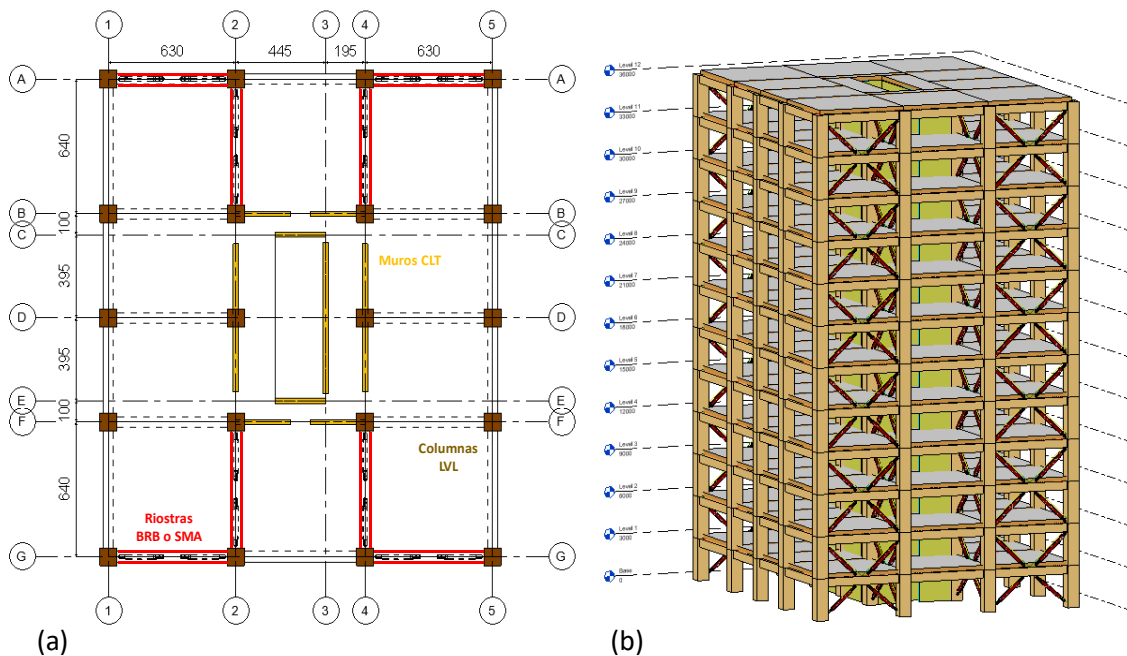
(a) Planta tipo de la estructura, basada en el sistema “FFTT” de Green and Karsh [60]; (b) modelo Revit, vista 3D.
